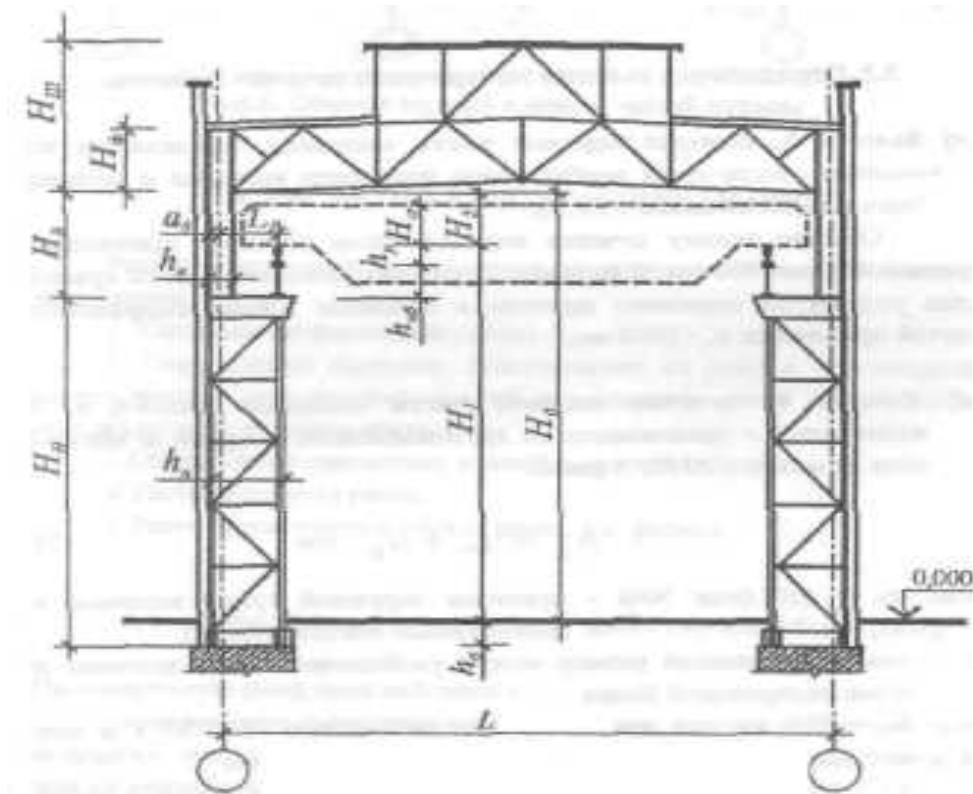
Схема поперечної рами однопролітного будівлі
